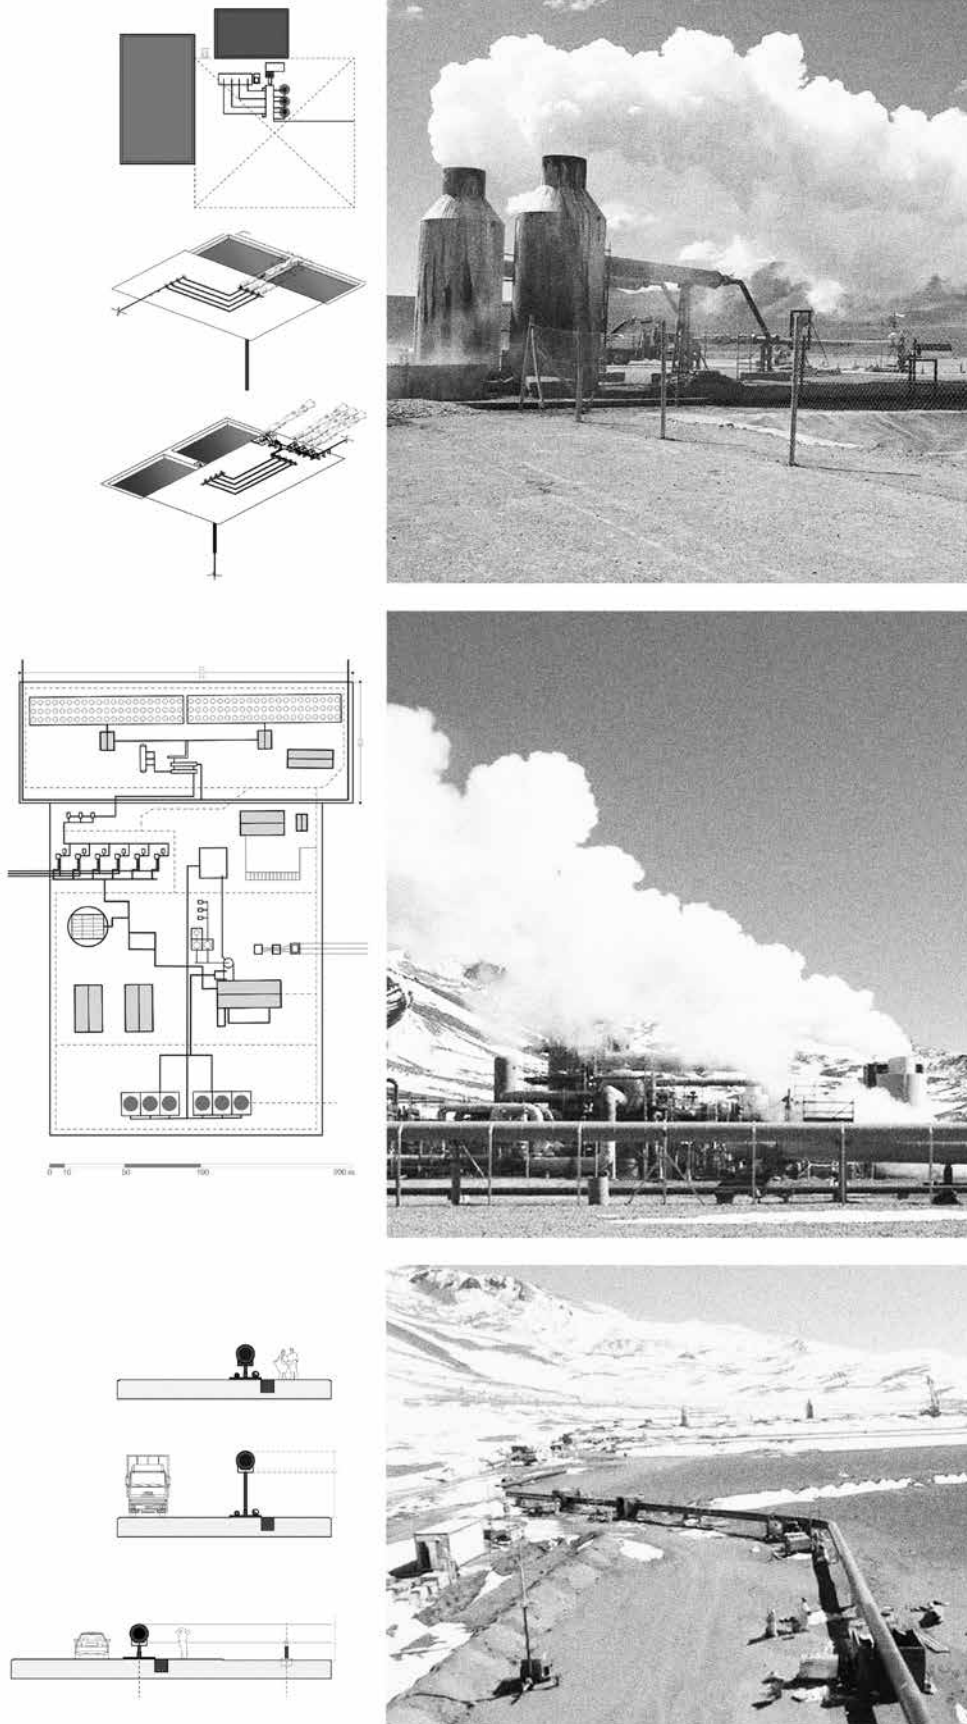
Despiece de la geotermia en Cerro Pabellón. De arriba hacia abajo: planta pozo extractivo tipo e isométricas de los pozos de extracción y reinyección; planta de la central geotérmica, cortes de ducto de transporte de fluido geotérmico. © Constanza Bianchini, 2019.
